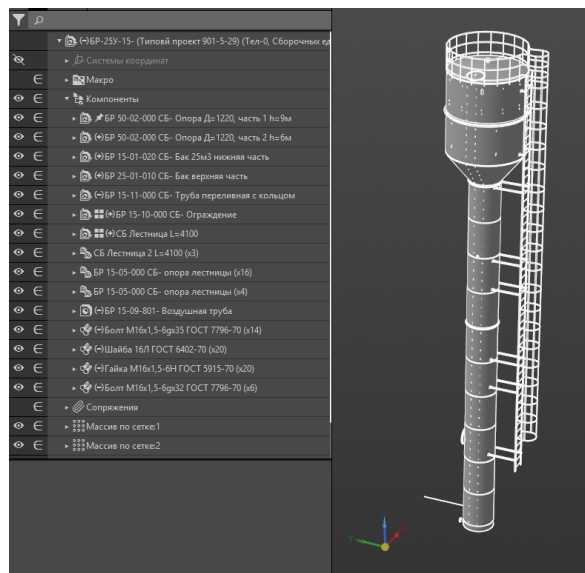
Эскизный чертёж башни Рожновского 25 м³ в Autocad
